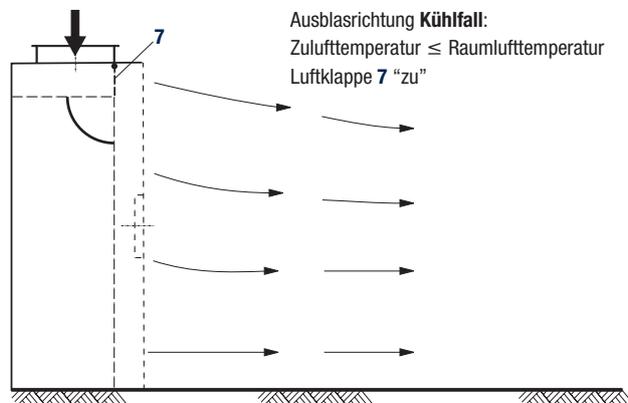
Rechteckiger Verdrängungsauslass mit Verstelleinrichtung
